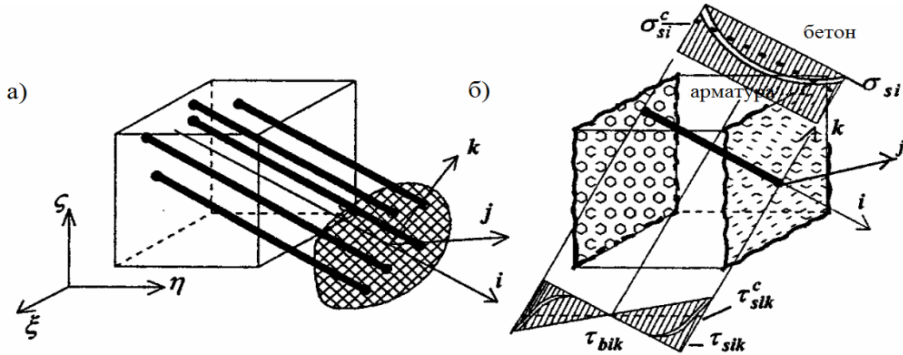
Железобетонный элемент: а) без трещин; б) с трещинами
